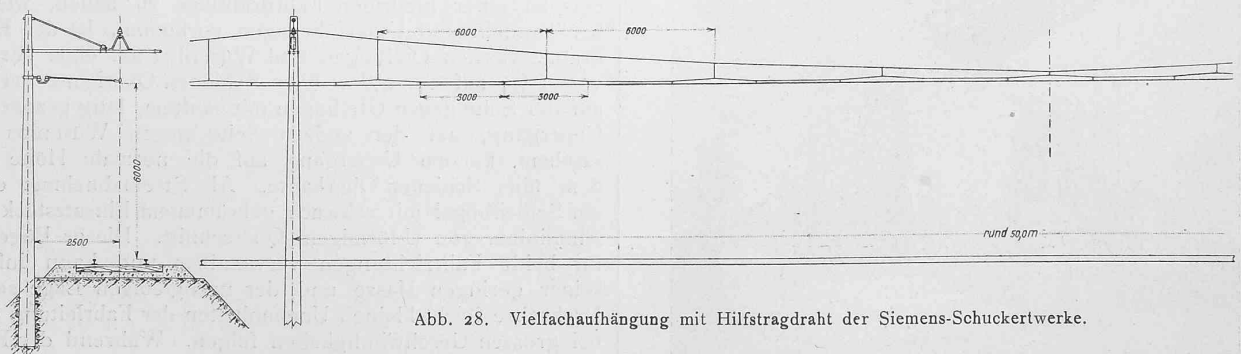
Vielfachaufhängung mit Hilfstragdraht der Siemens-Schuckertwerke.
